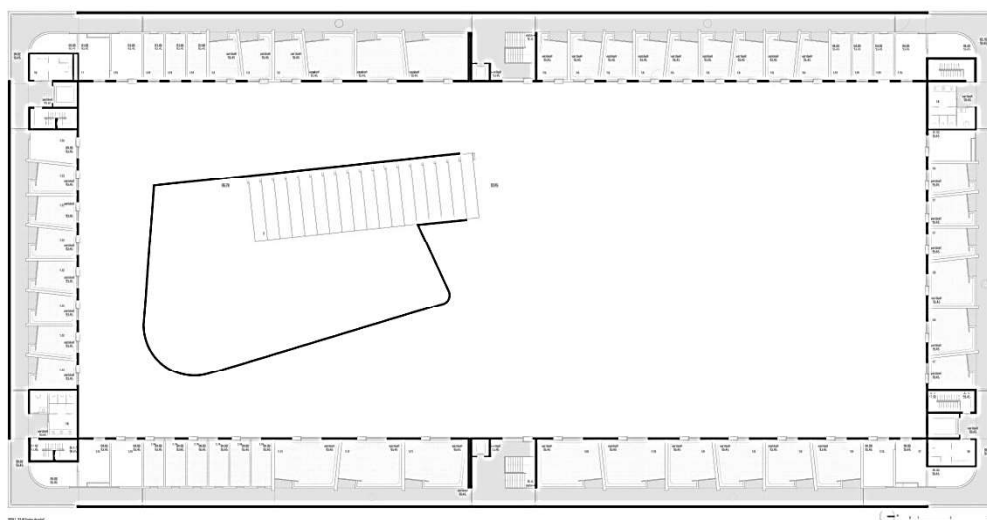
Planta do primeiro pavimento, nível do pátio das salas de aula. (Fonte: Open Buildings, 2013).
